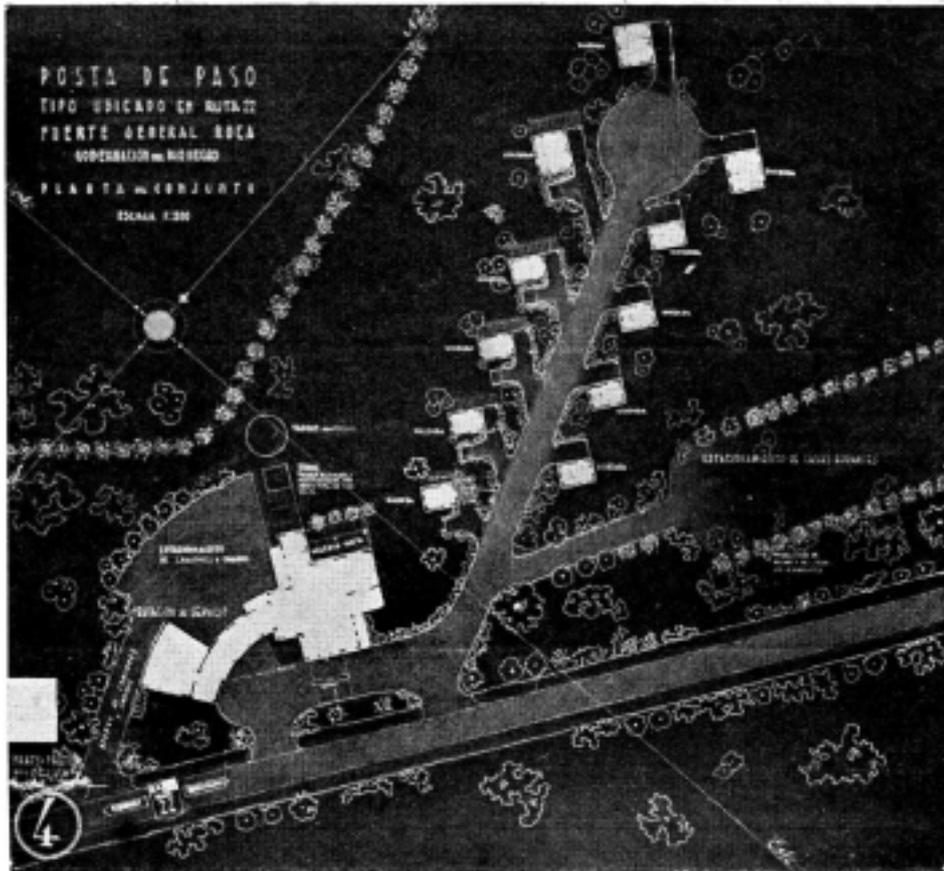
Plano de Posta de paso. Proyecto Una Posta. Revista de Arquitectura N.º 266. Febrero 1946. p. 47.
